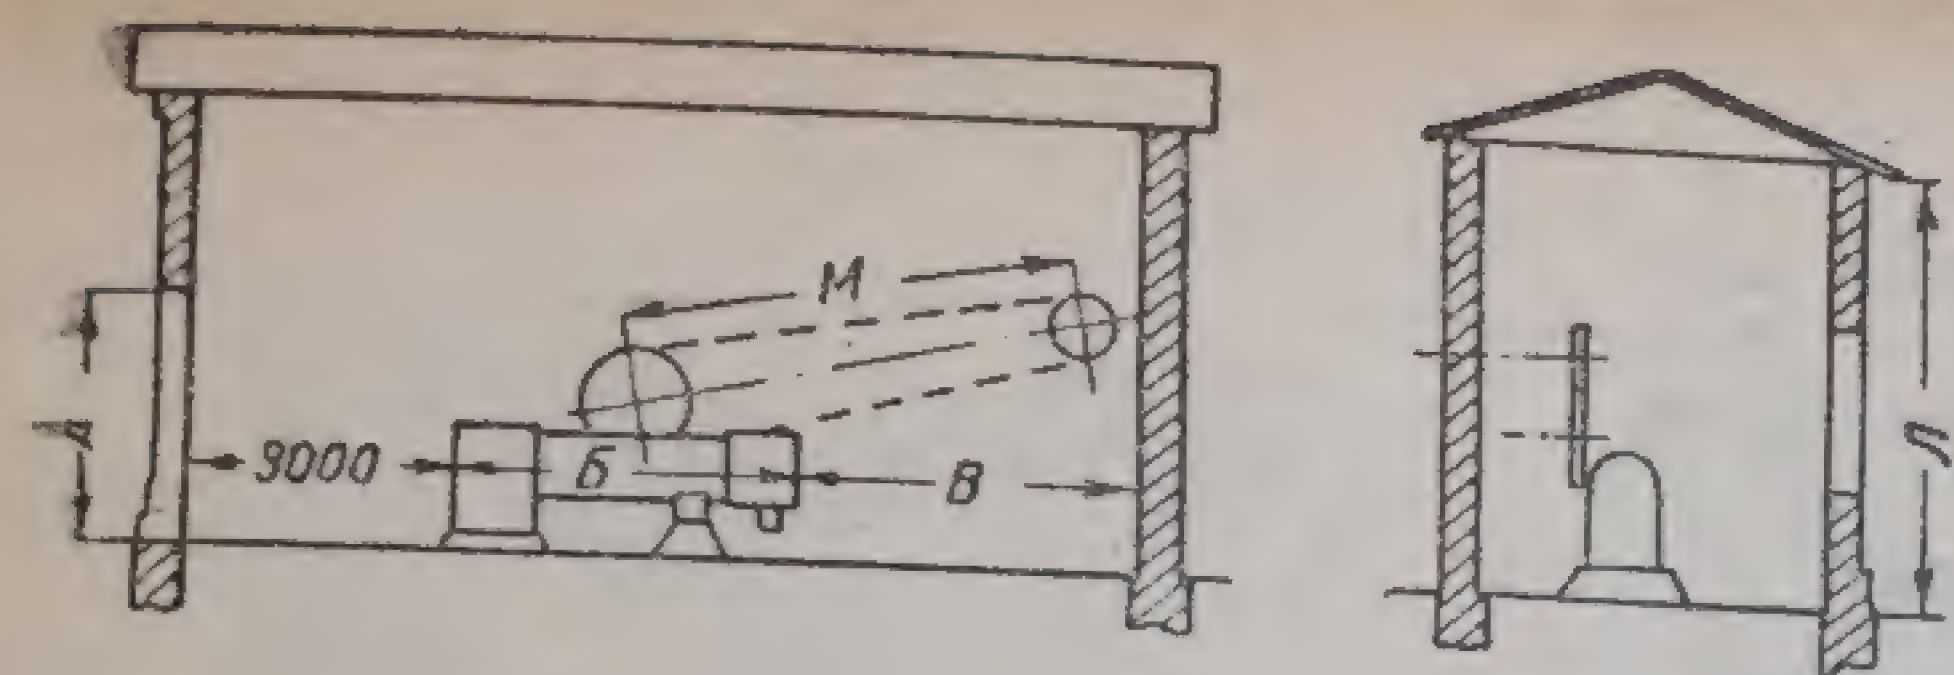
Монтажный чертеж для установки локомотива классов А и П:
